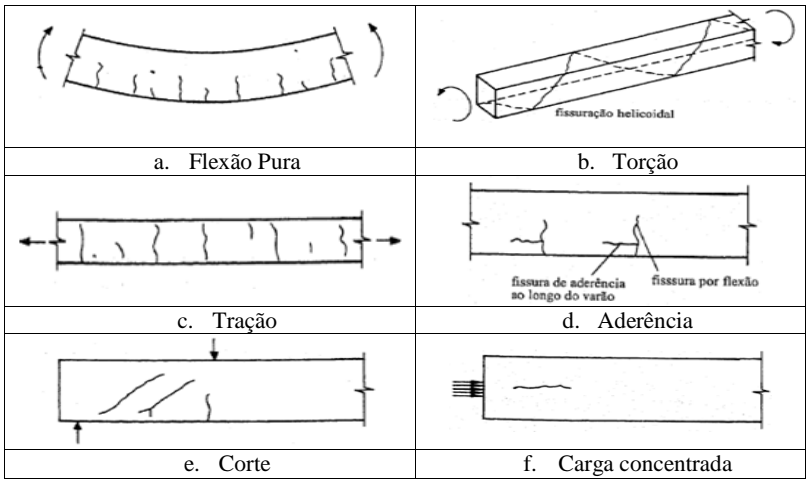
Tipos de fissuras (adaptado de CEB,1992 e CEB,2002)
